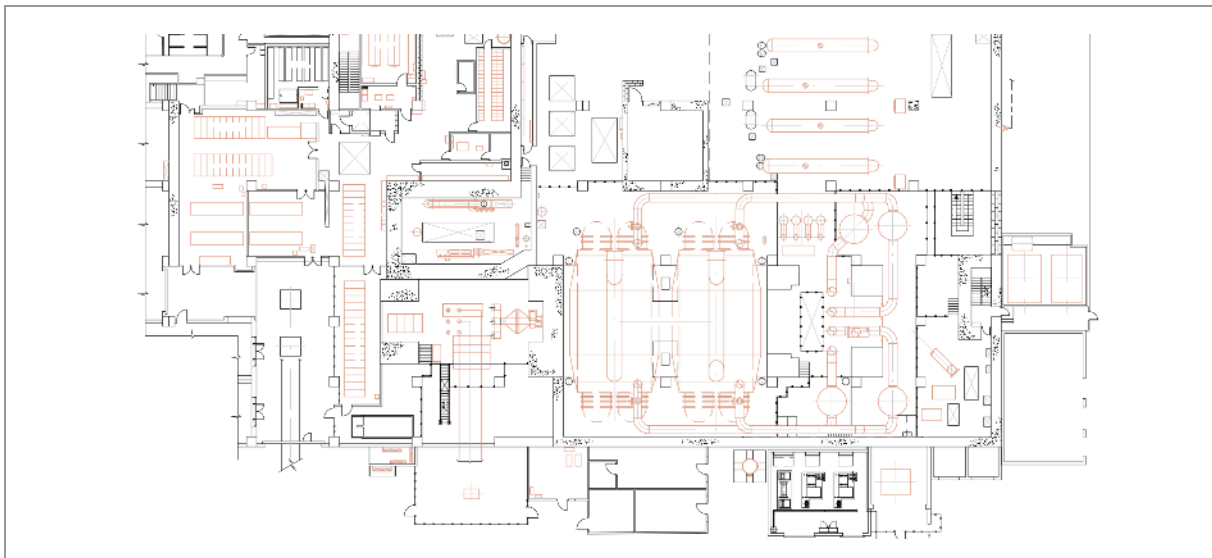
Disposición general entreplanta Edificio de Turbina, elevación 518,20
